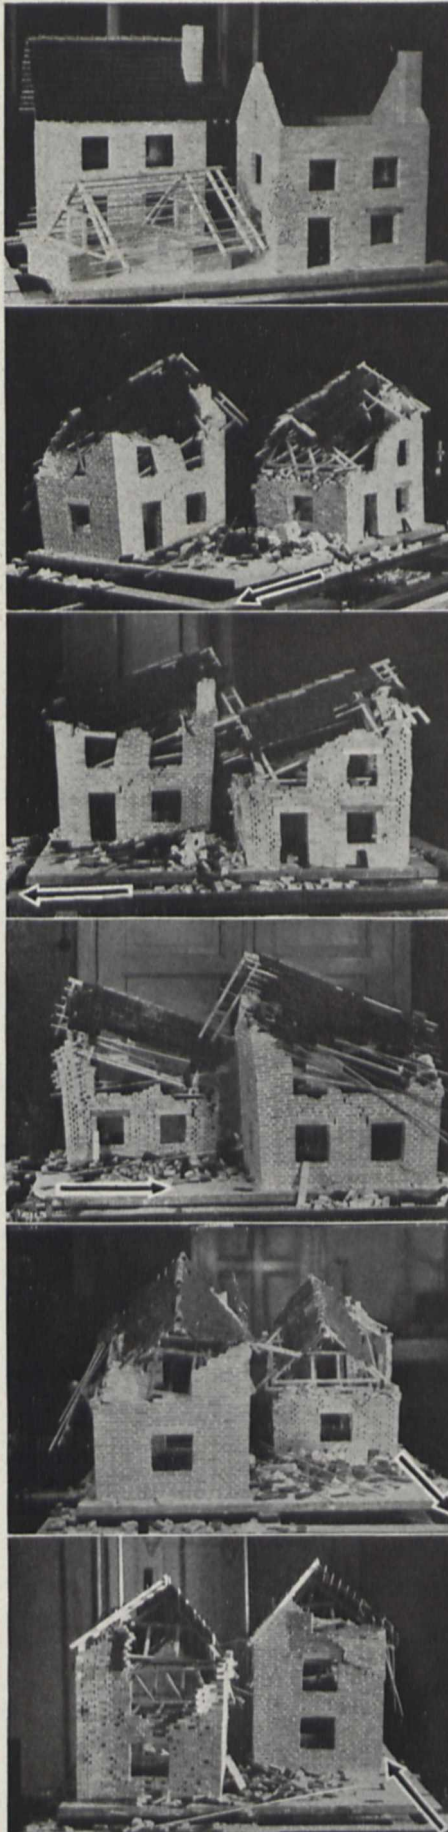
(links). Zerstörung je eines Modellhauses mit Mörtel- und Trockenmauerwerk durch Stoß auf die Giebelmauern
